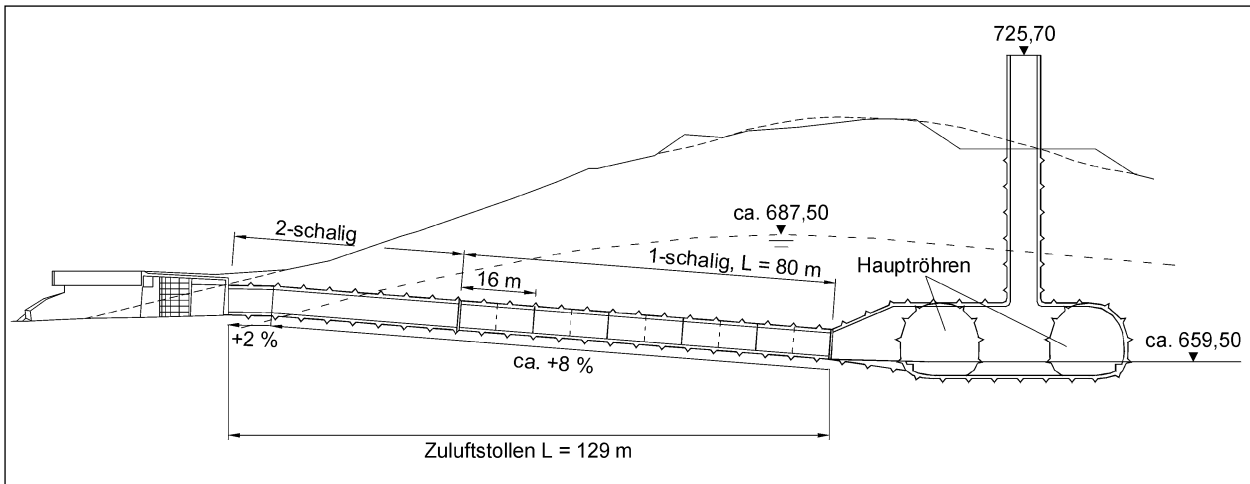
Konstruktionsaufbauten der Versuchsstrecke
